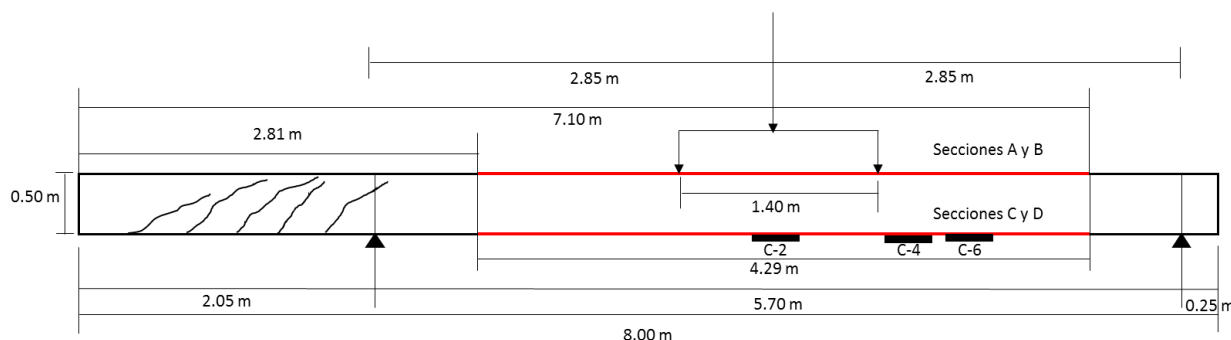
Aspecto de la viga I-3 previo al ensayo a flexión.
